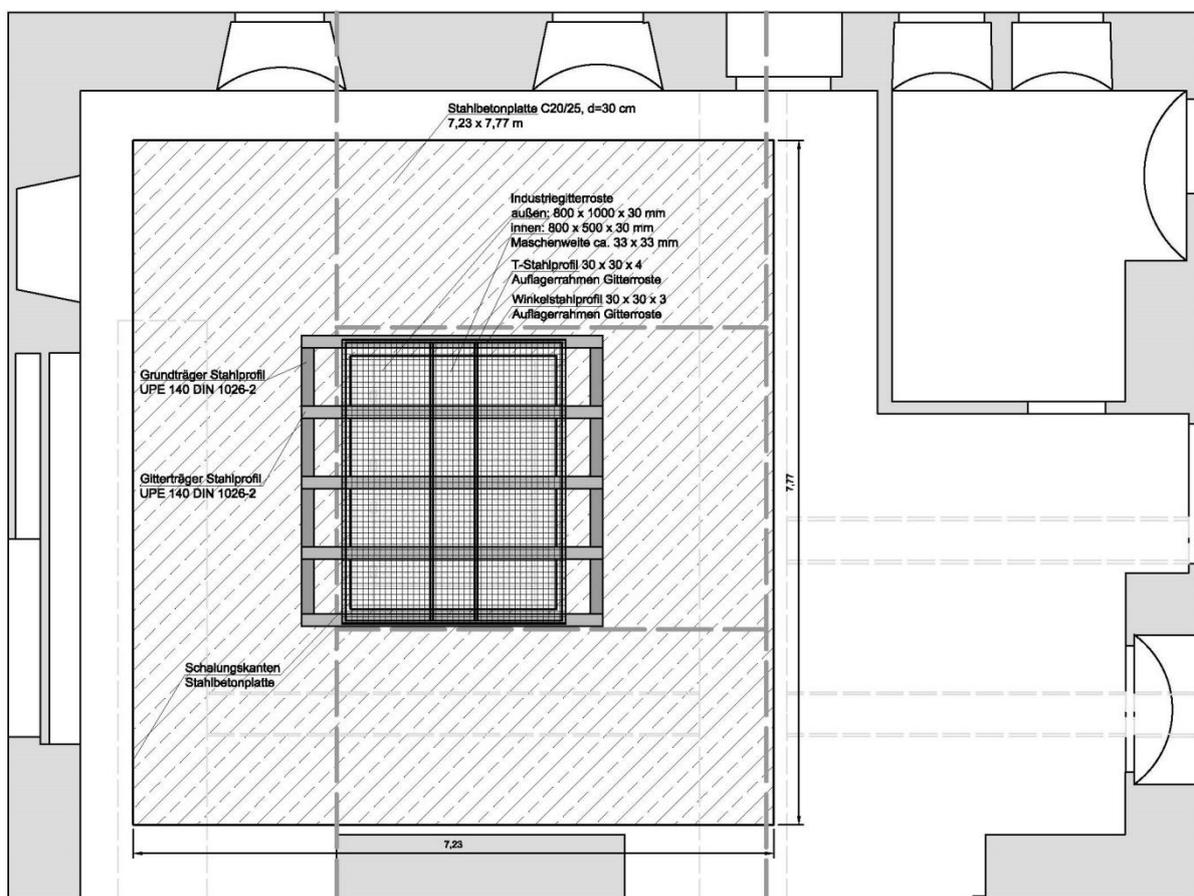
Schematischer Grundriss Schachtkopfsanierung innerhalb der Gebäuderuine
